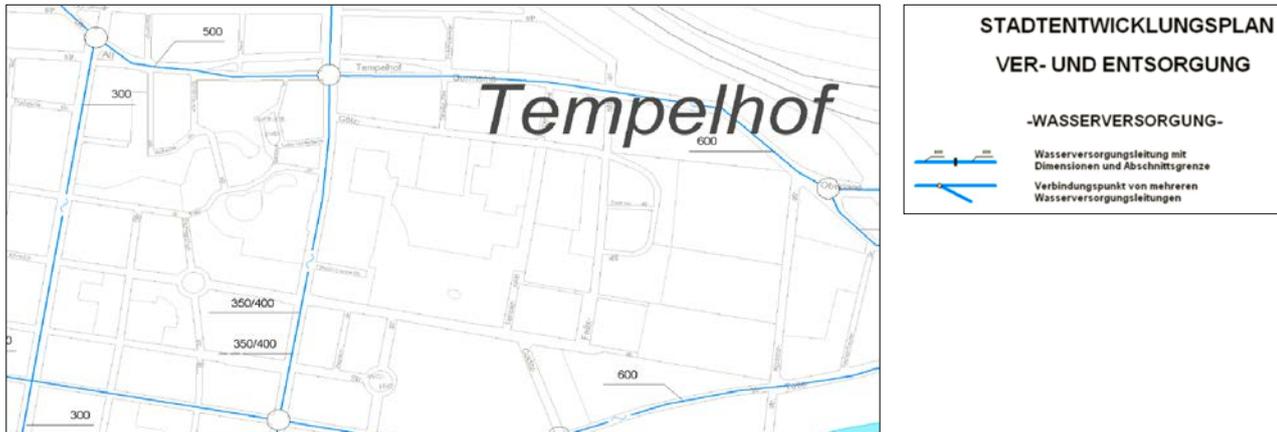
Stadtentwicklungsplan Ver- und Entsorgung - Wasserversorgung (Ausschnitt) (ebda.)
